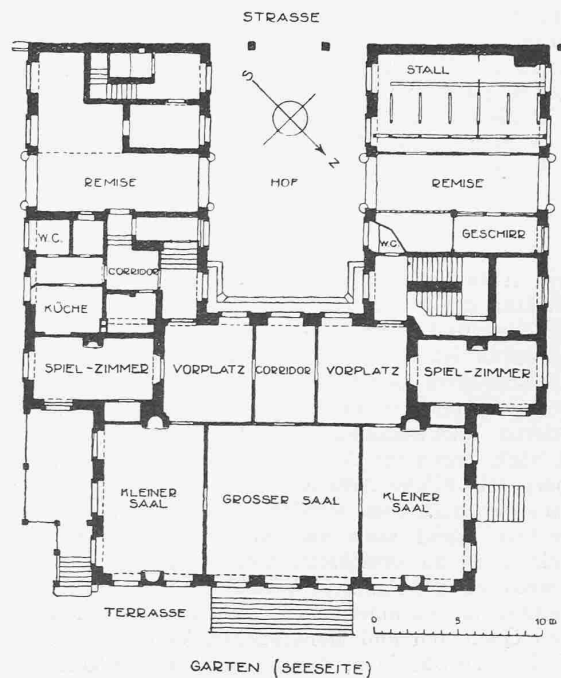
Erdgeschoss-Grundriss des Muraltengutes, vor dem Umbau.
